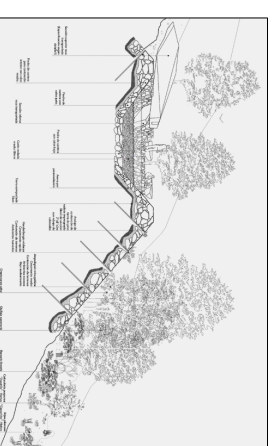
Masterplan Reforestación Quebrada San Ramón Fuente:
